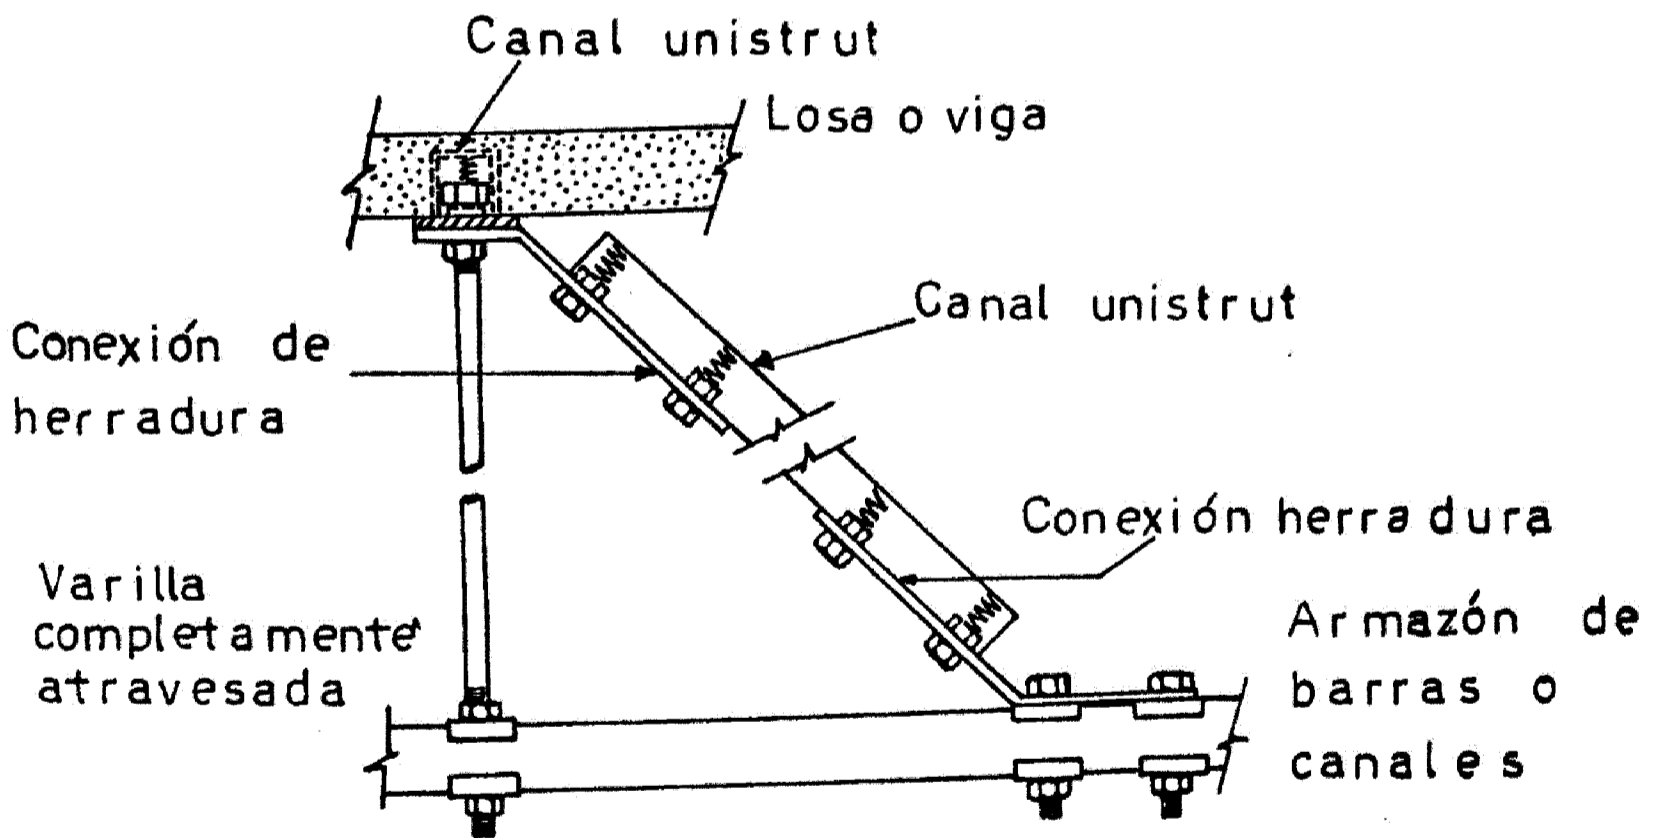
Equipo de permutación soporte estructural Sistema 2 canal de acero atornillado por vía de concreto insertado a la estructura del techo
